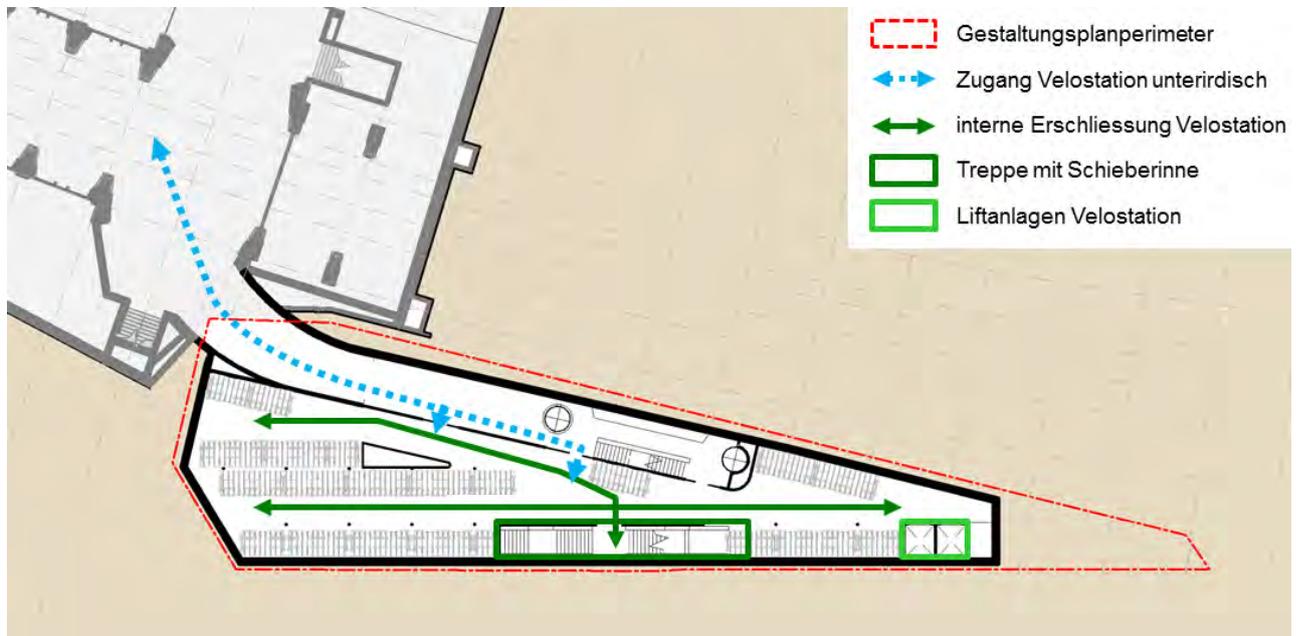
Zugang Velostation unterirdisch – Situationsplan (Geschoss -2) Richtprojekt „Haus zum Falken“ (Quelle: Calatrava Valls SA, Zürich, Dezember 2015)
